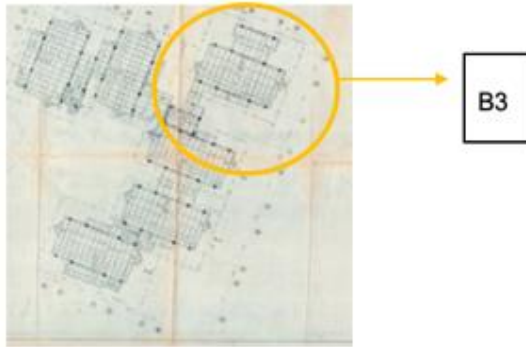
Tercera Placa - Plano estructural TB 2.
